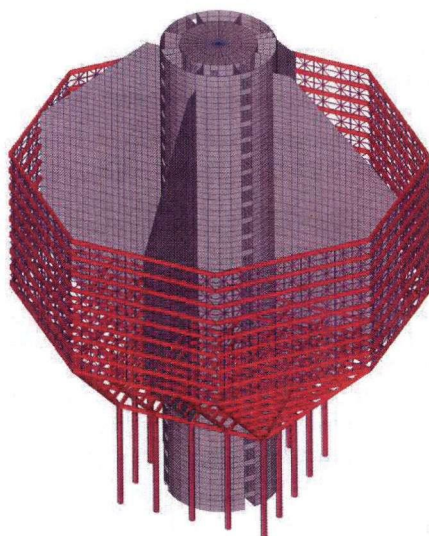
Вариант 2 конструктивной схемы здания книгохранилища (несущими элементами, воспринимающими нагрузку от элементов каркаса, являются круглый железобетонный ствол с 4-мя диафрагмами, раскосная решетка по периметру и трубобетонные колонны)
